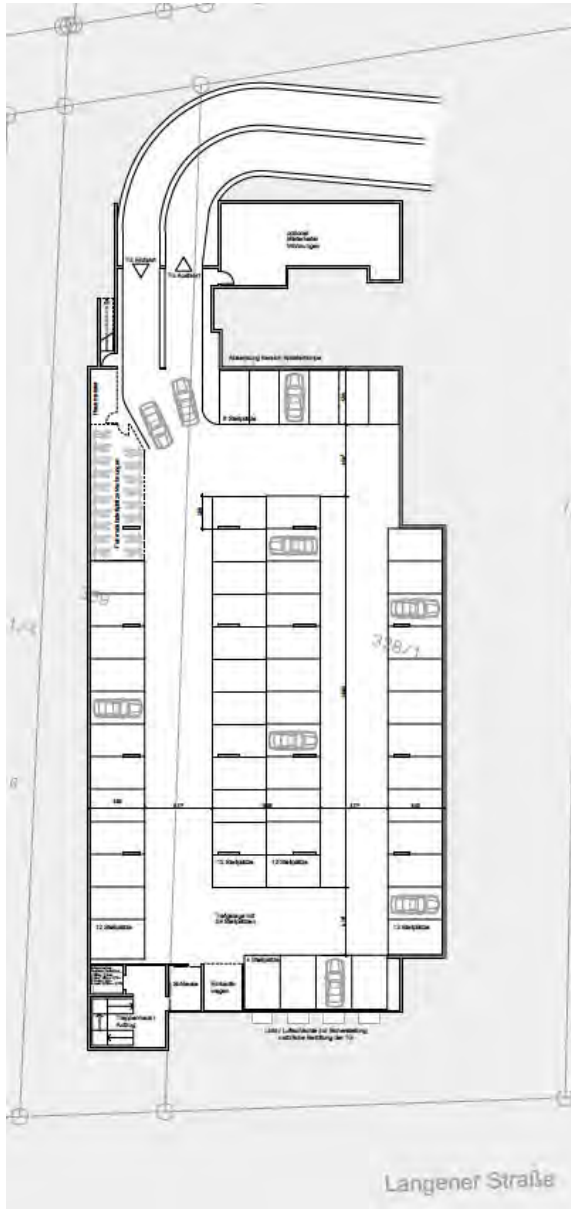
Grundriss der Tiefgarage [1.c]
